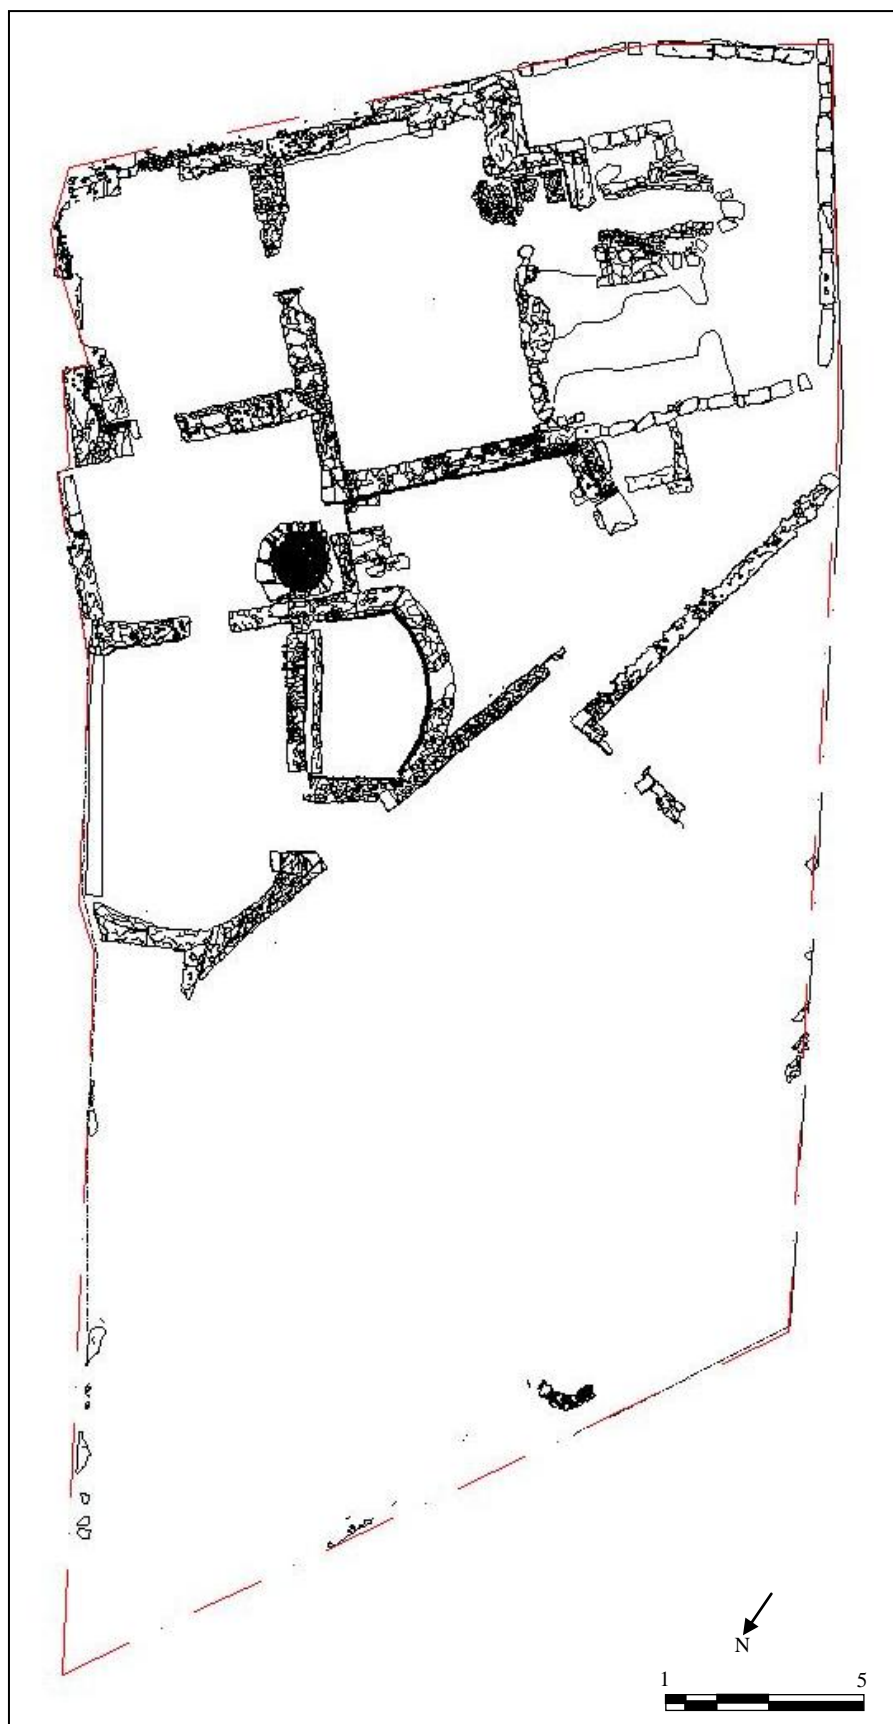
Planimetria ricavata a quota +1.20m con la caratterizzazione delle strutture.
